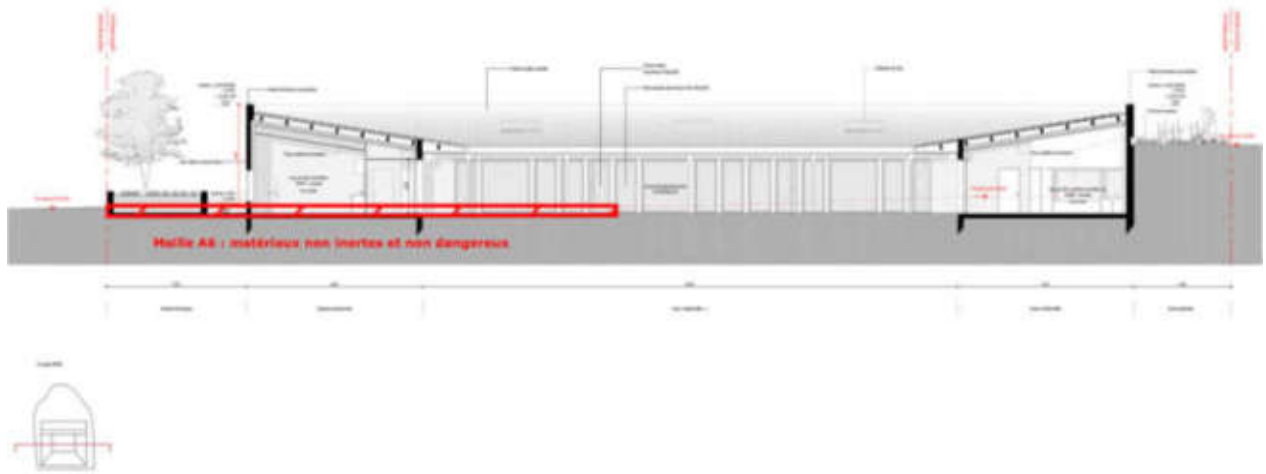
Classement déchet des matériaux compris entre 0 et 2 m de profondeur au droit du site (Source : APAVE ; mars 2023)
